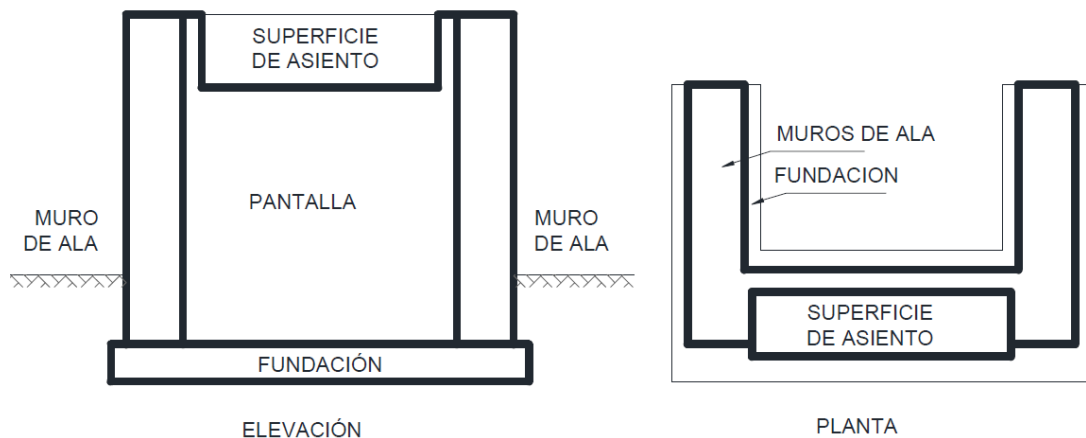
Esquema general de la vista en planta y elevación del estribo.
